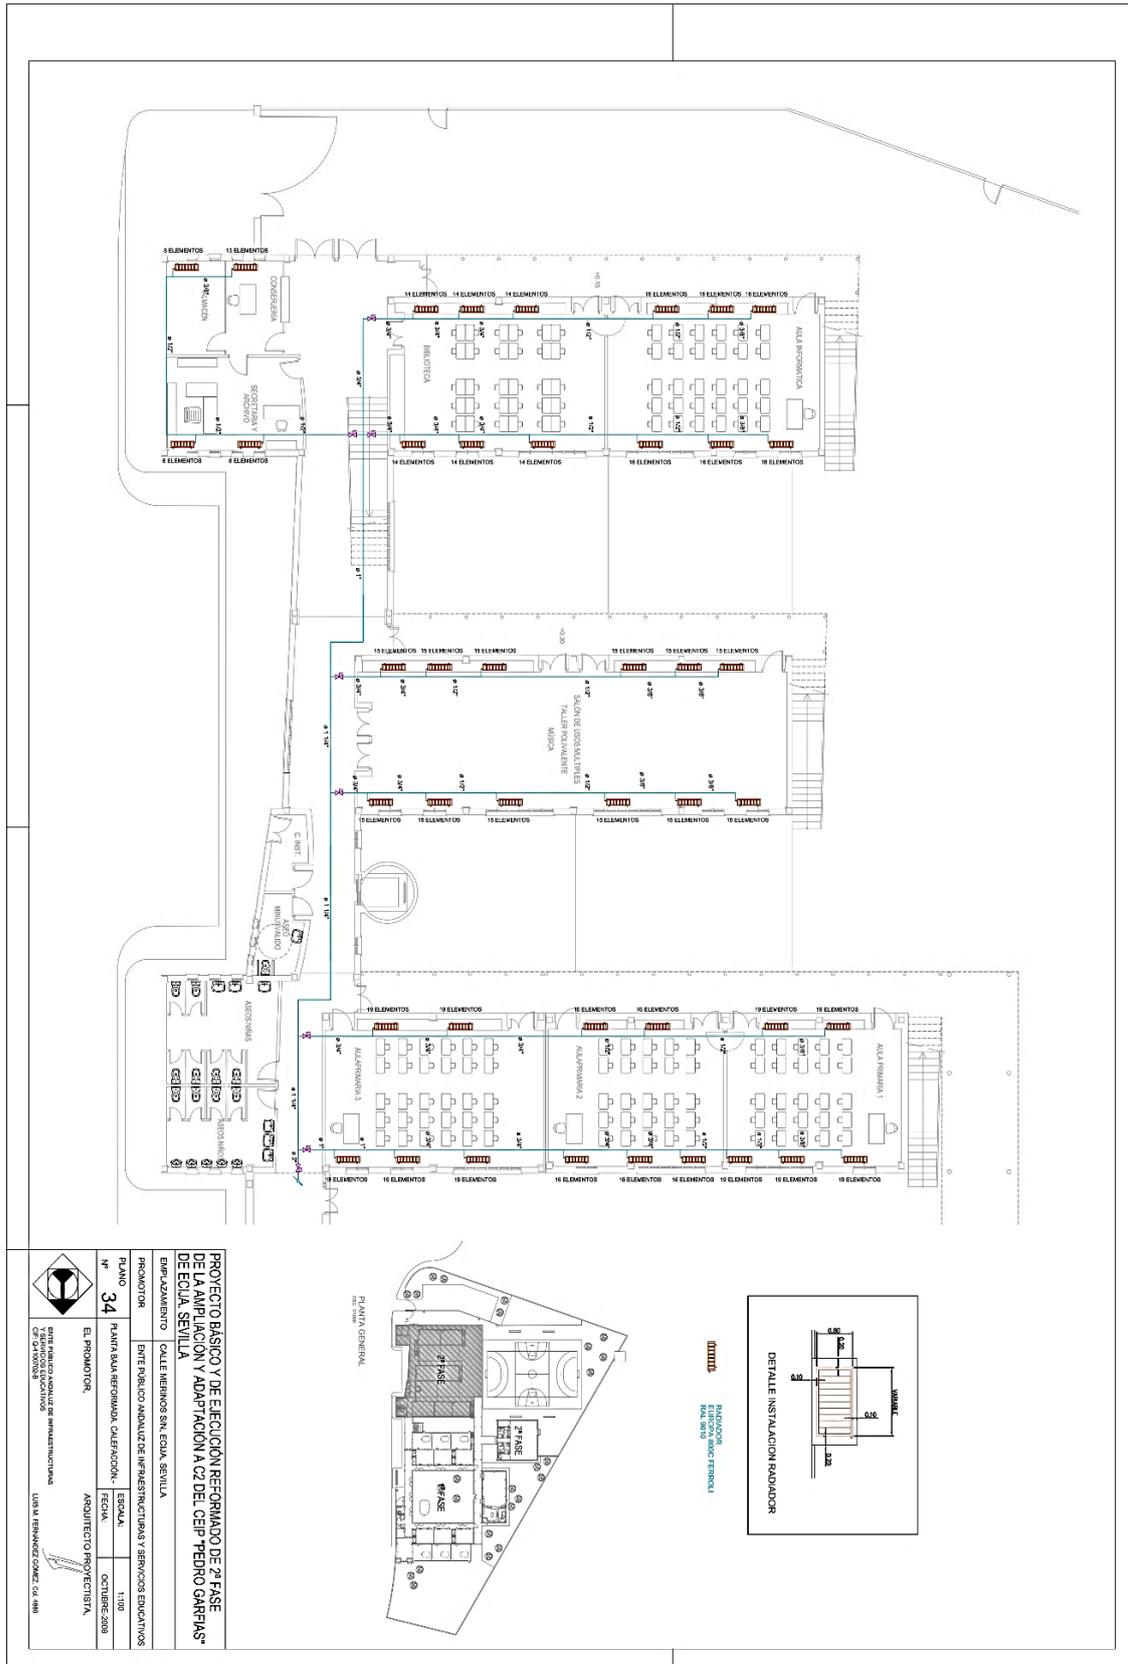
Plano riesgos calefacción Edificio Primaria planta baja.
